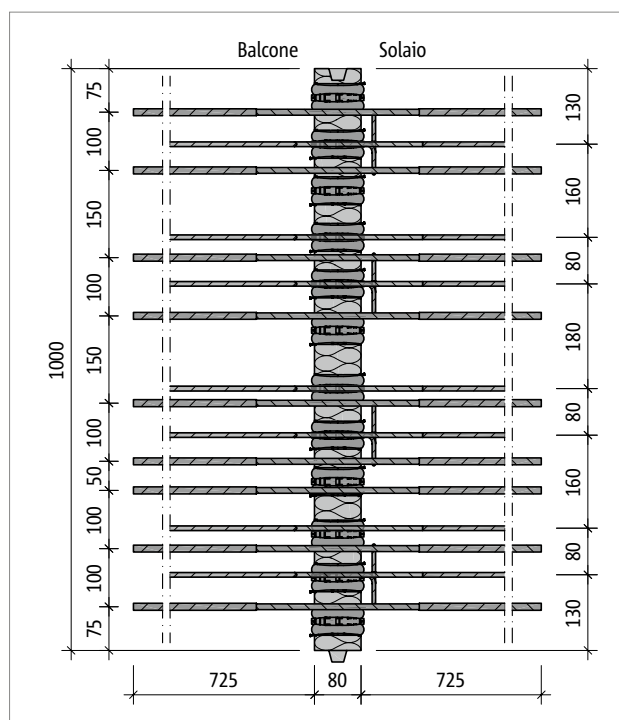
Schöck Isokorb® T tipo K-M8-V1: pianta del prodotto
